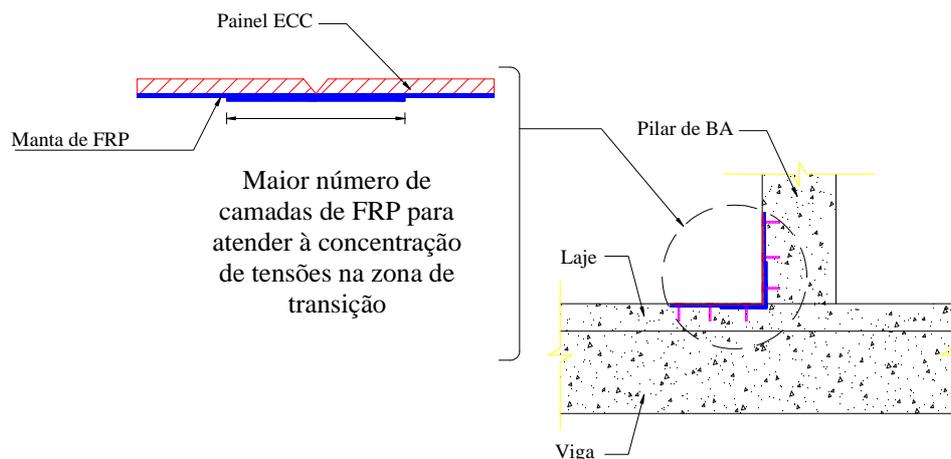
Painel ECC(FRP) para o reforço da ligação pilar-viga.
